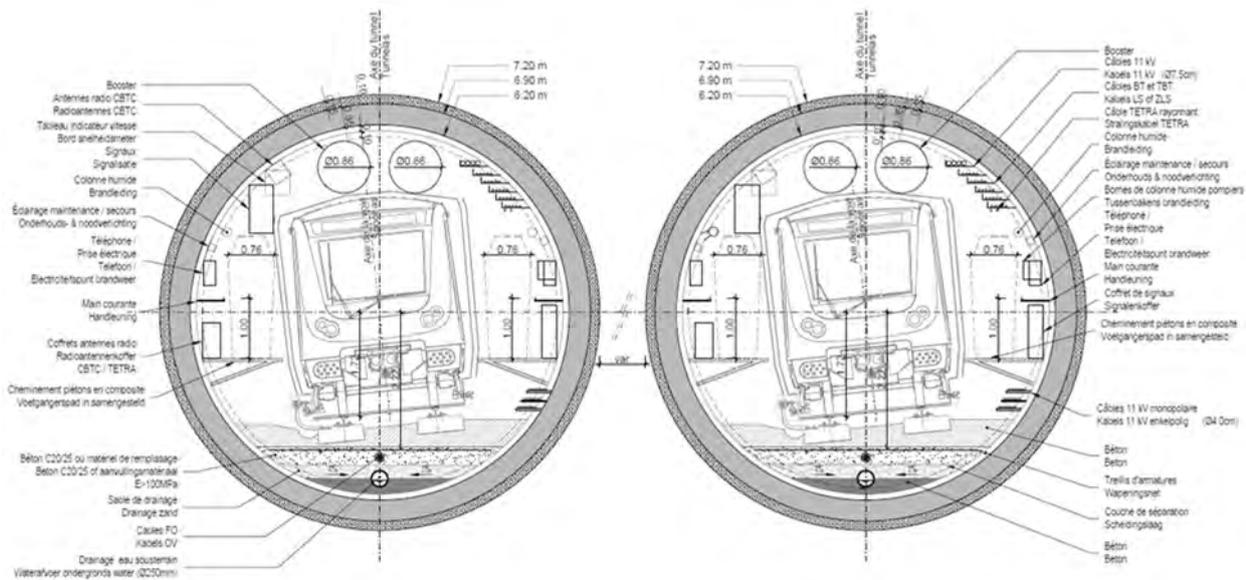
coupe de principe des tunnels dans l'alternative bitube (BMN, 2020)
